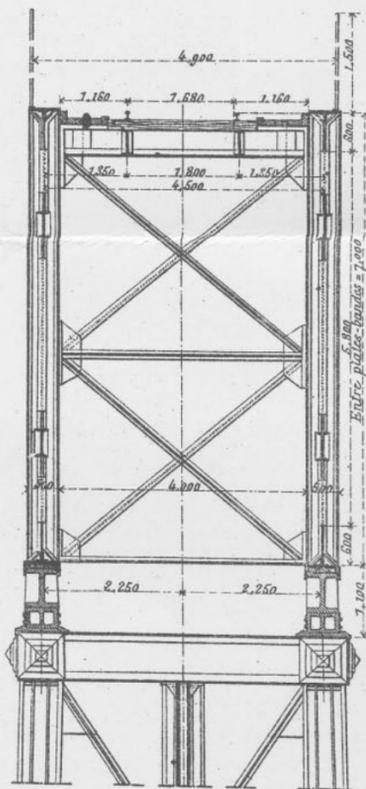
Corte i Elevacion longitudinal Escala 1/100
